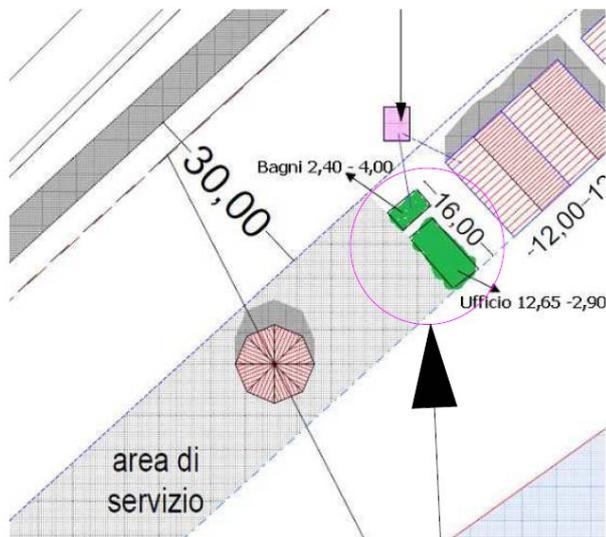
/5: Planimetria edifici di servizio (bagno e ufficio)
